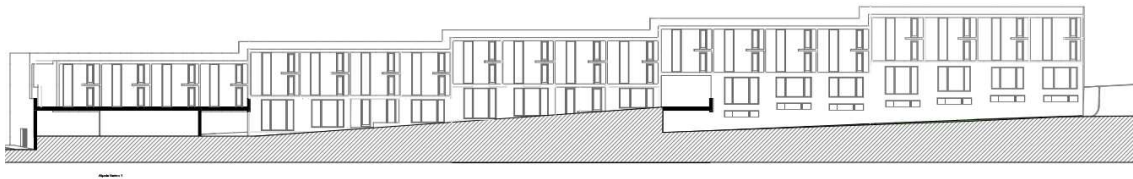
Evolução da proposta_alçado Norte (interior da praçeta) _27/06/2014
